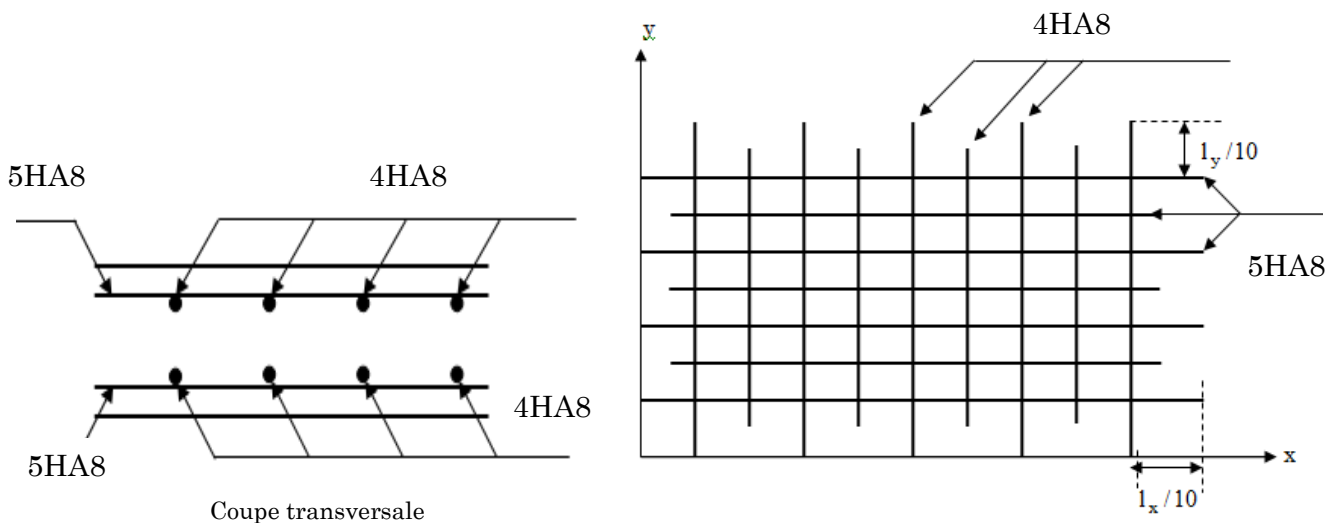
Schéma de ferrailage de la dalle d'ascenseur
